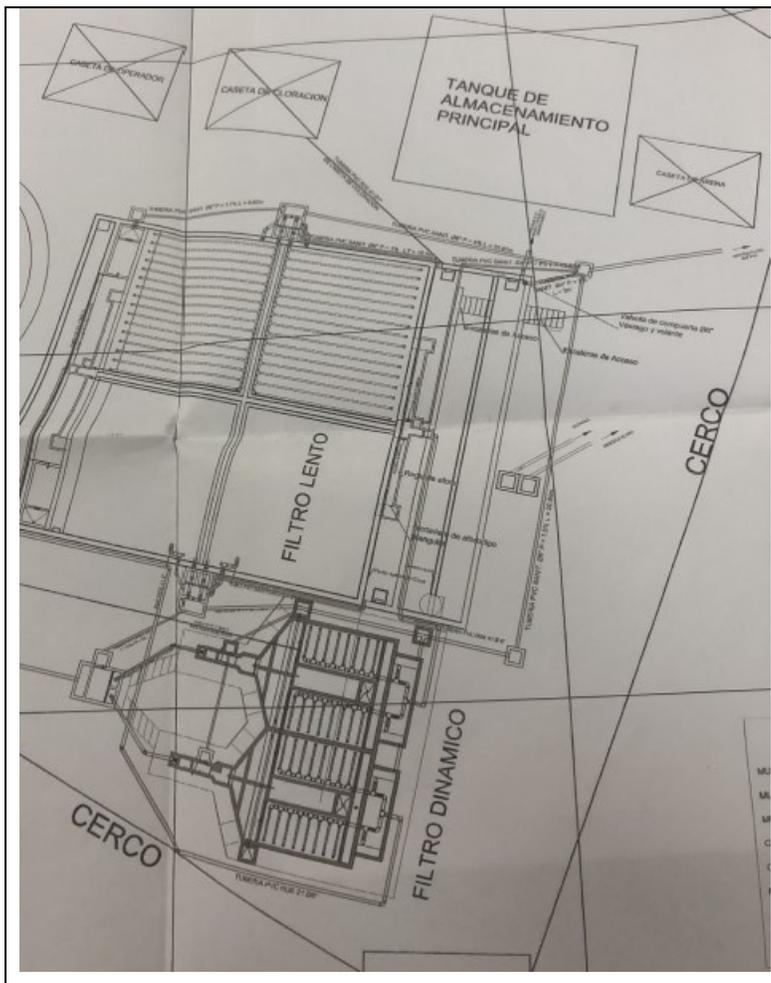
PLANO PTAP VISTA PLANTA - FUENTE GESTION DOCUMENTAL MUNICIPIO.
